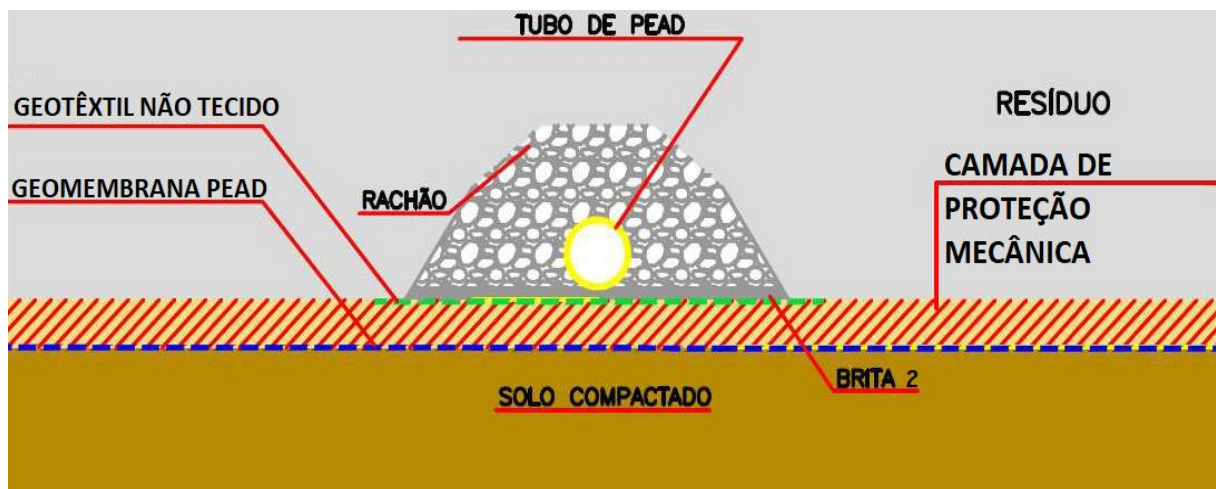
Croqui esquemático do dreno principal acima da camada de proteção mecânica. Fonte: Autor.
